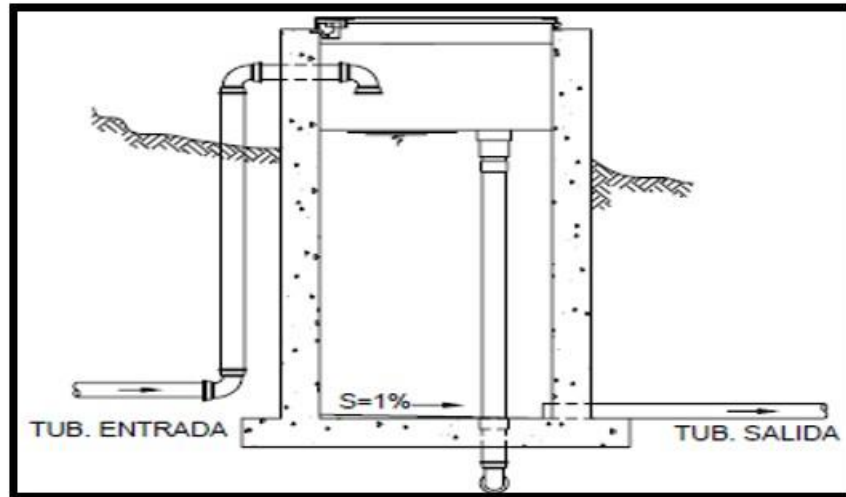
Cámara rompe – presión. Fuente: Salvador T.(2004)
